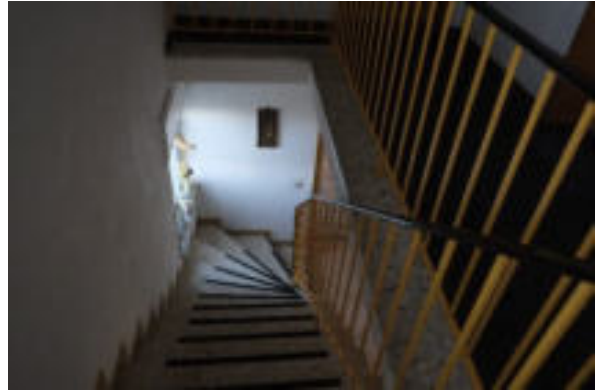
Blick in den Flur / Diele im Erdgeschoss
